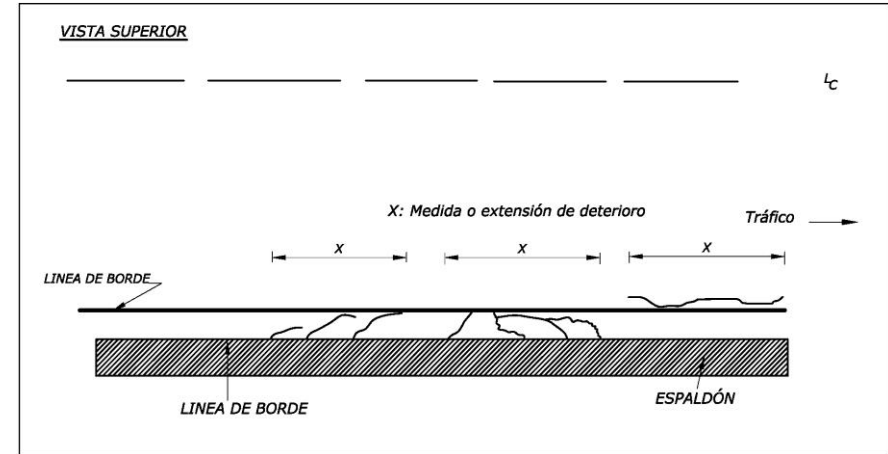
Esquema Grietas de Borde– Pavimento Flexible
